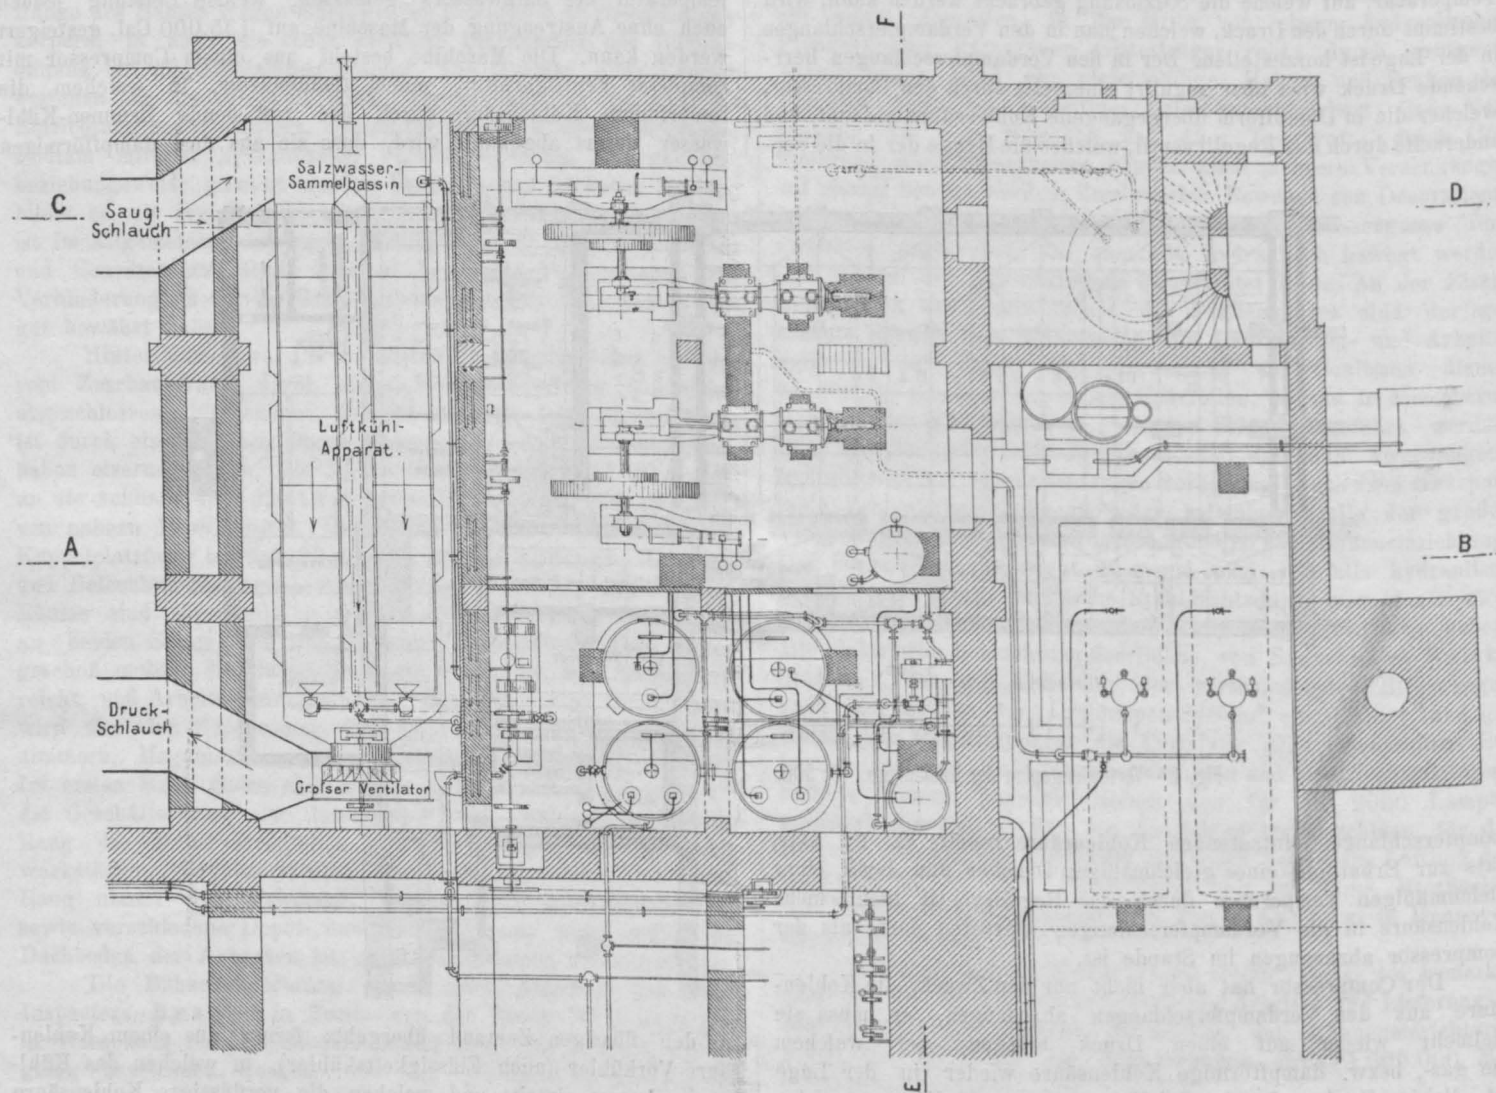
Grundriss der Maschinen- und Kühlanlage. 1:200.
